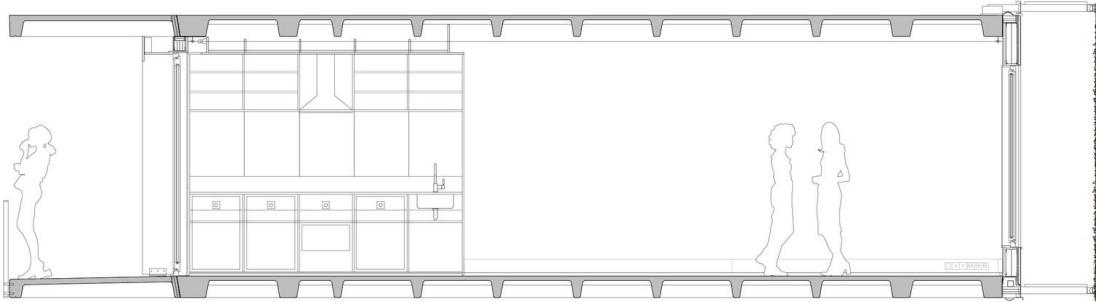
Grundriss und Schnitt des Zimmermoduls
